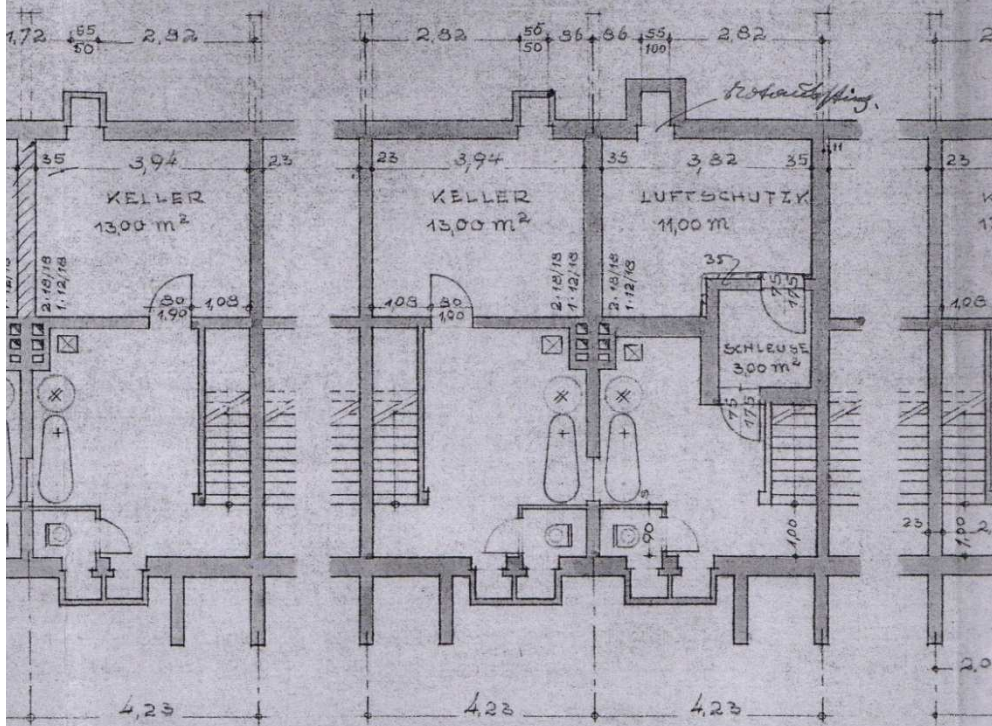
Grundriss Kellergeschoss aus der Bauantragszeichnung 1939
